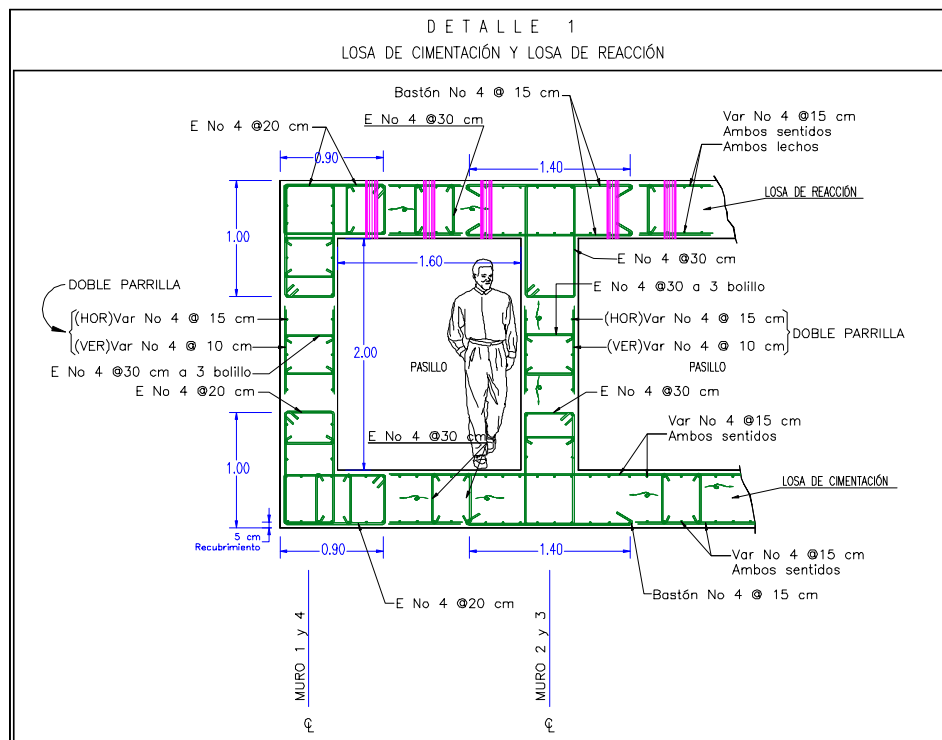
Detalle 1, muestra el armado resultado de cálculo para la losa de cimentación y para la losa de reacción
